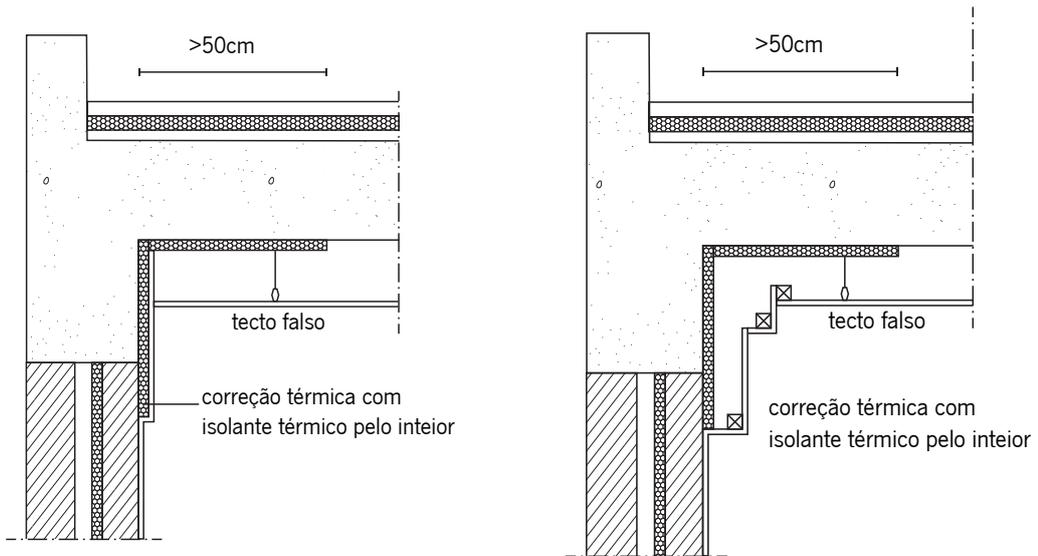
Pormenor de Correção em tecto falso com isolamento térmico pelo interior na zona de ligação parede exterior e laje pontual
